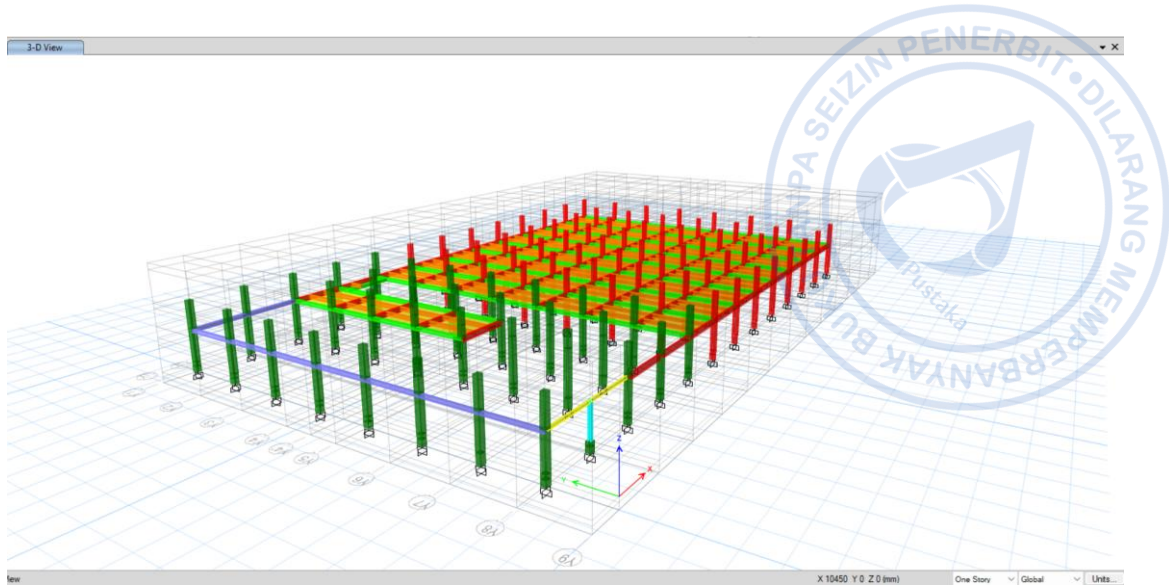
72. Pemodelan Slab 150 Pada Lantai 2
